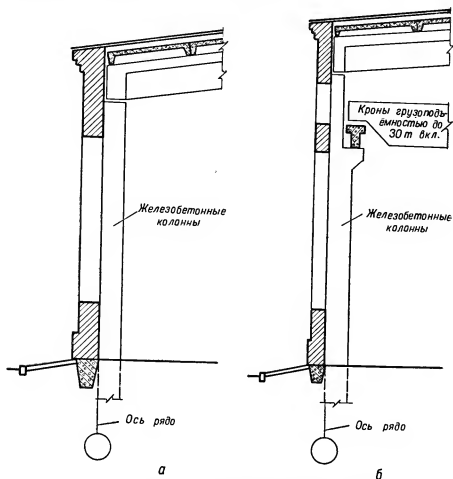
11. Привязка железобетонных колонн в цехах:
